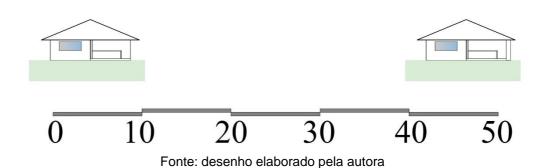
Fachadas Cabanas Tipo 1 e Tipo 2
